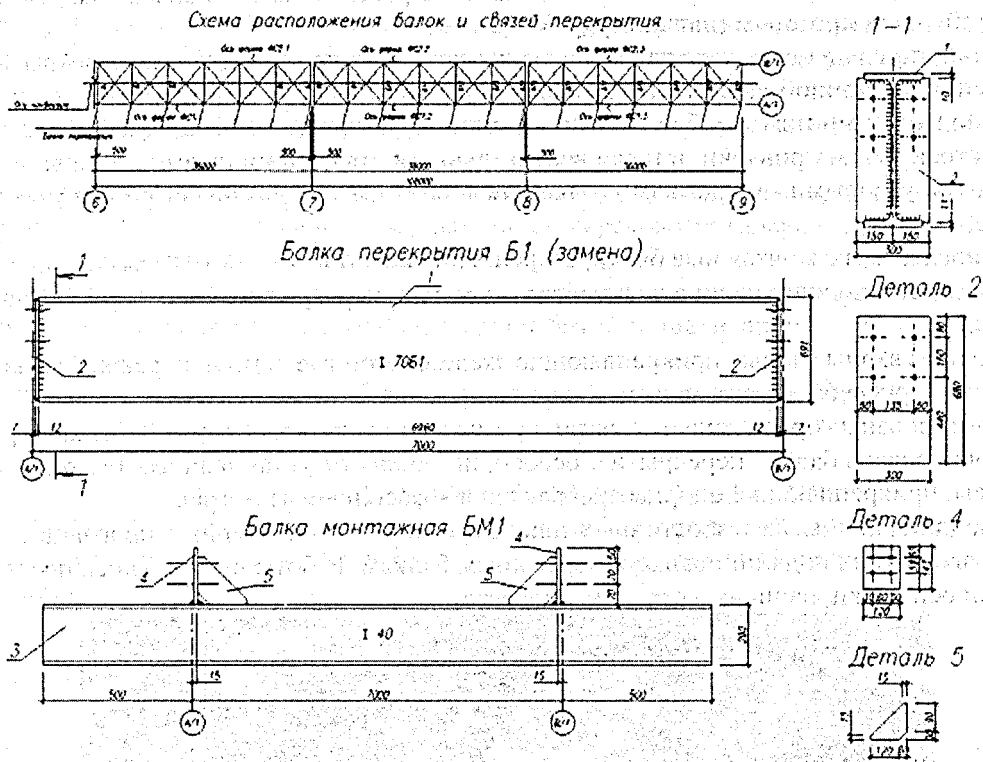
Балка замены Б1 и монтажная балка БМ1
